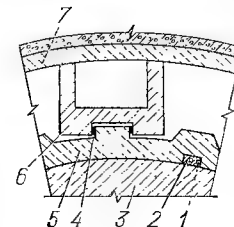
Раскрепление корпуса упорным кольцом.
